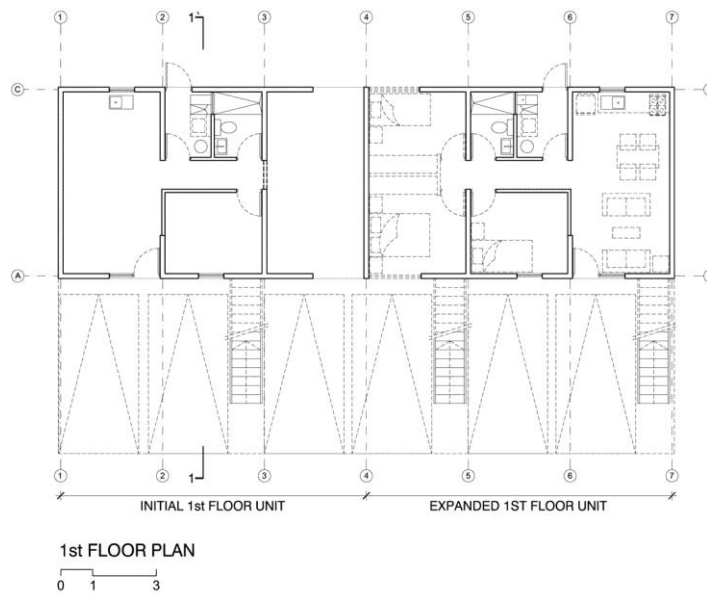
Planta Arquitectónica, Proyecto ELEMENTAL. Fuente: (Delaqua, 2010)
